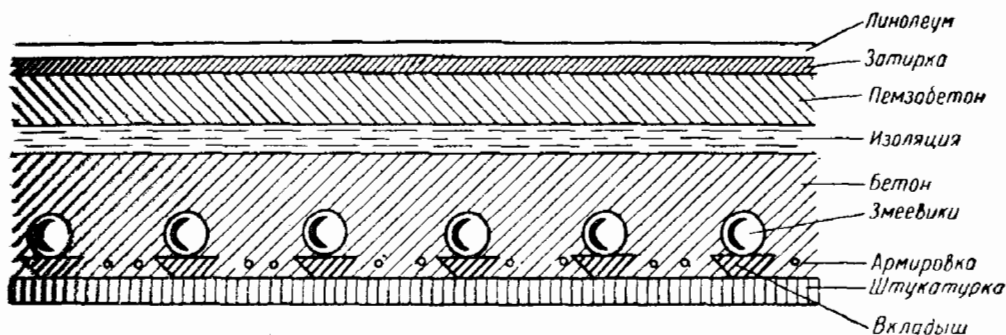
Конструкция бетонного перекрытия потолочной системы лучистого отопления
